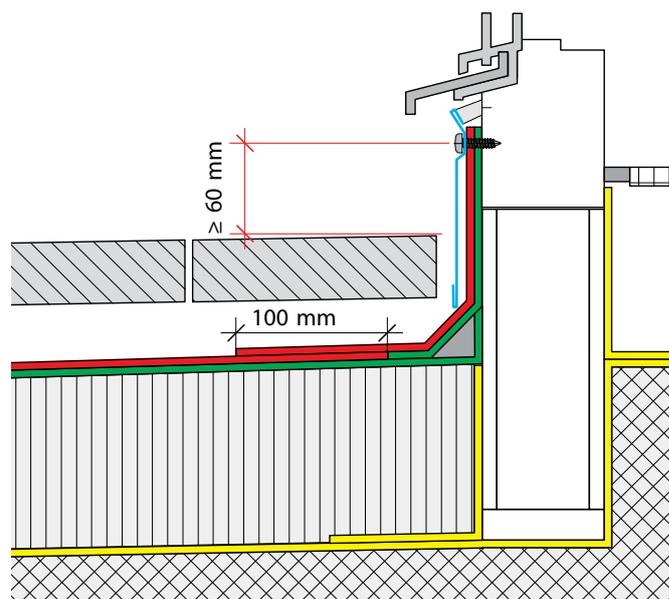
impermeabilizzazione bituminosa con cuneo elastomerico e banda del sole
